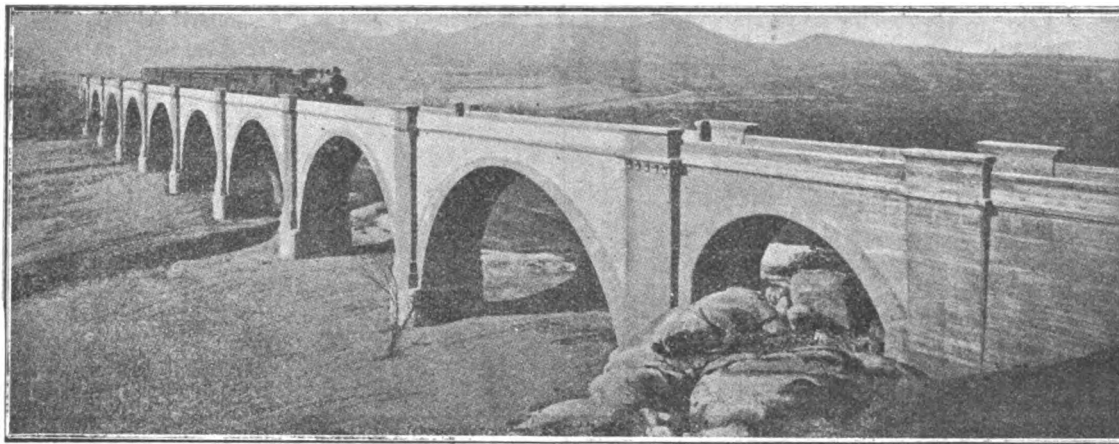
Viadotto in cemento armato sul fiume Sant'Anna.
